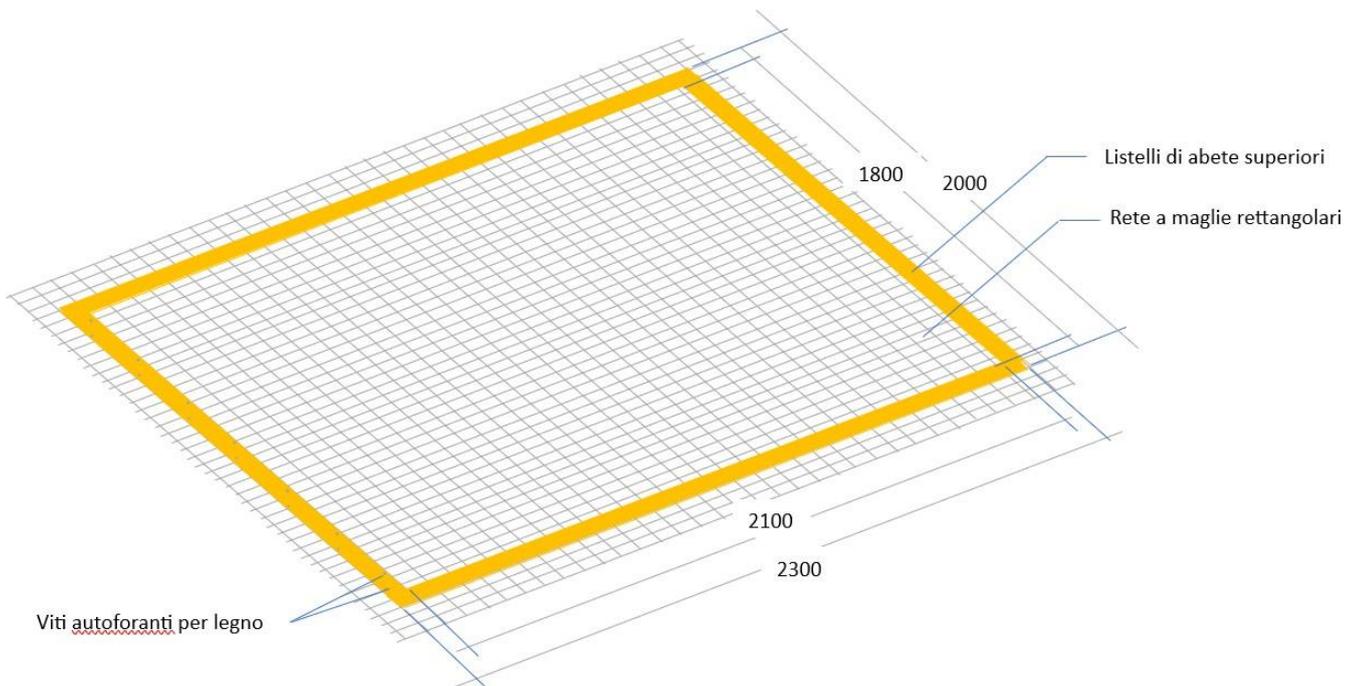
Schema di posa del campione di rete “First” pervenuto e sottoposto a prova
